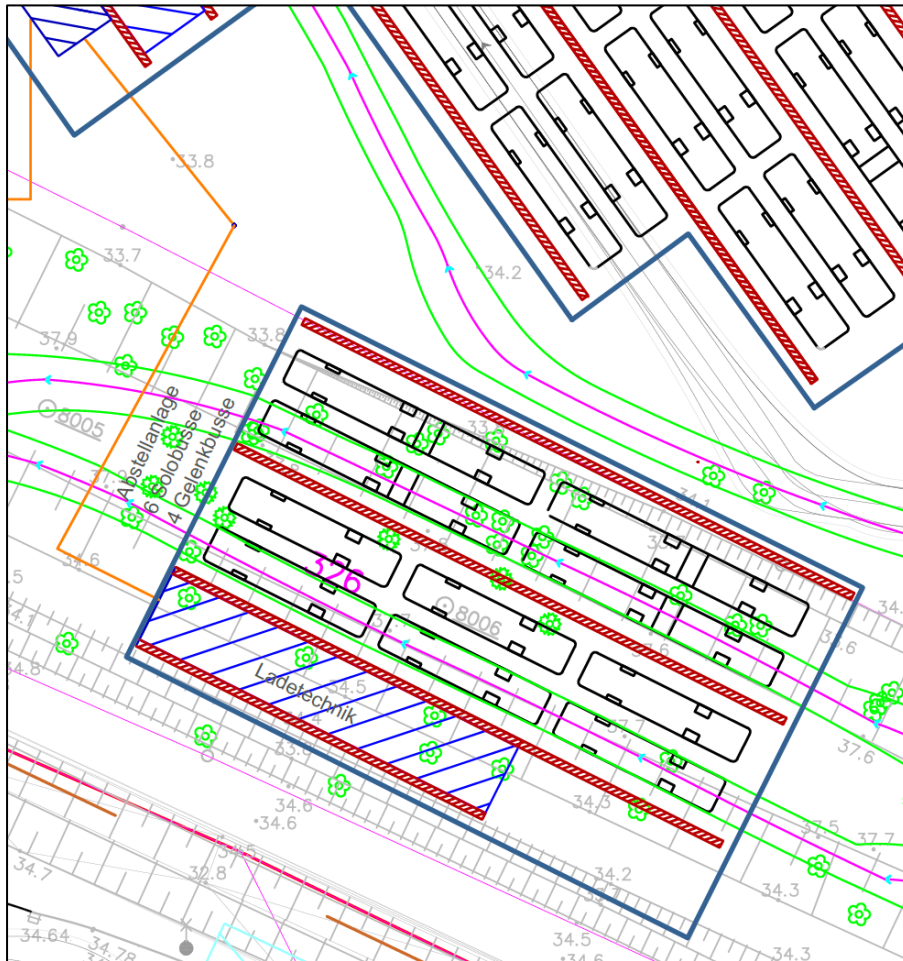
Germendorf Detailansicht Bauabschnitt 4
